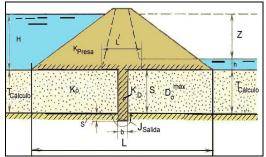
Presa (Núcleo) con Dentellón que llega hasta la capa impermeable.
